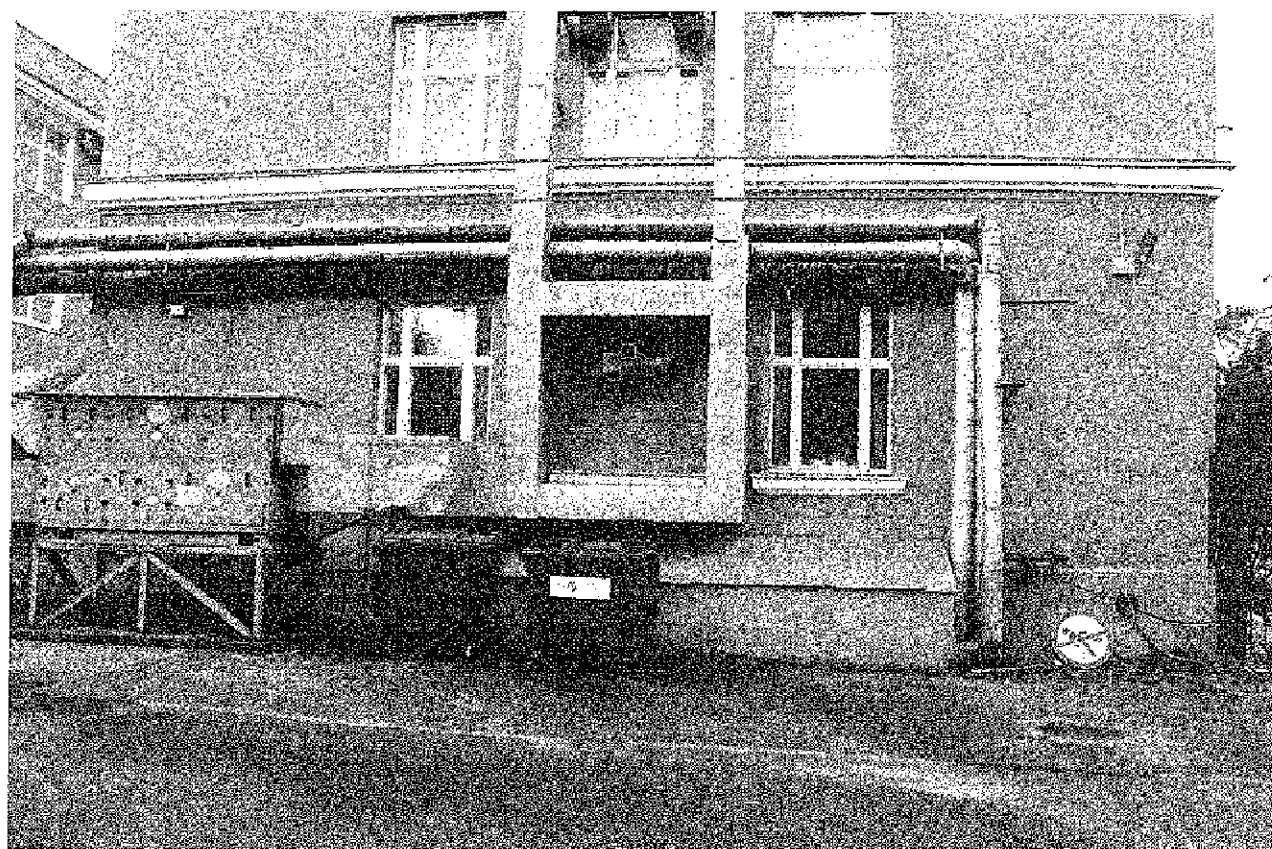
Профилированный межэтажный карниз между 1-м и 2-м этажом. Западный фасад здания. Дата: 14.07.2021
